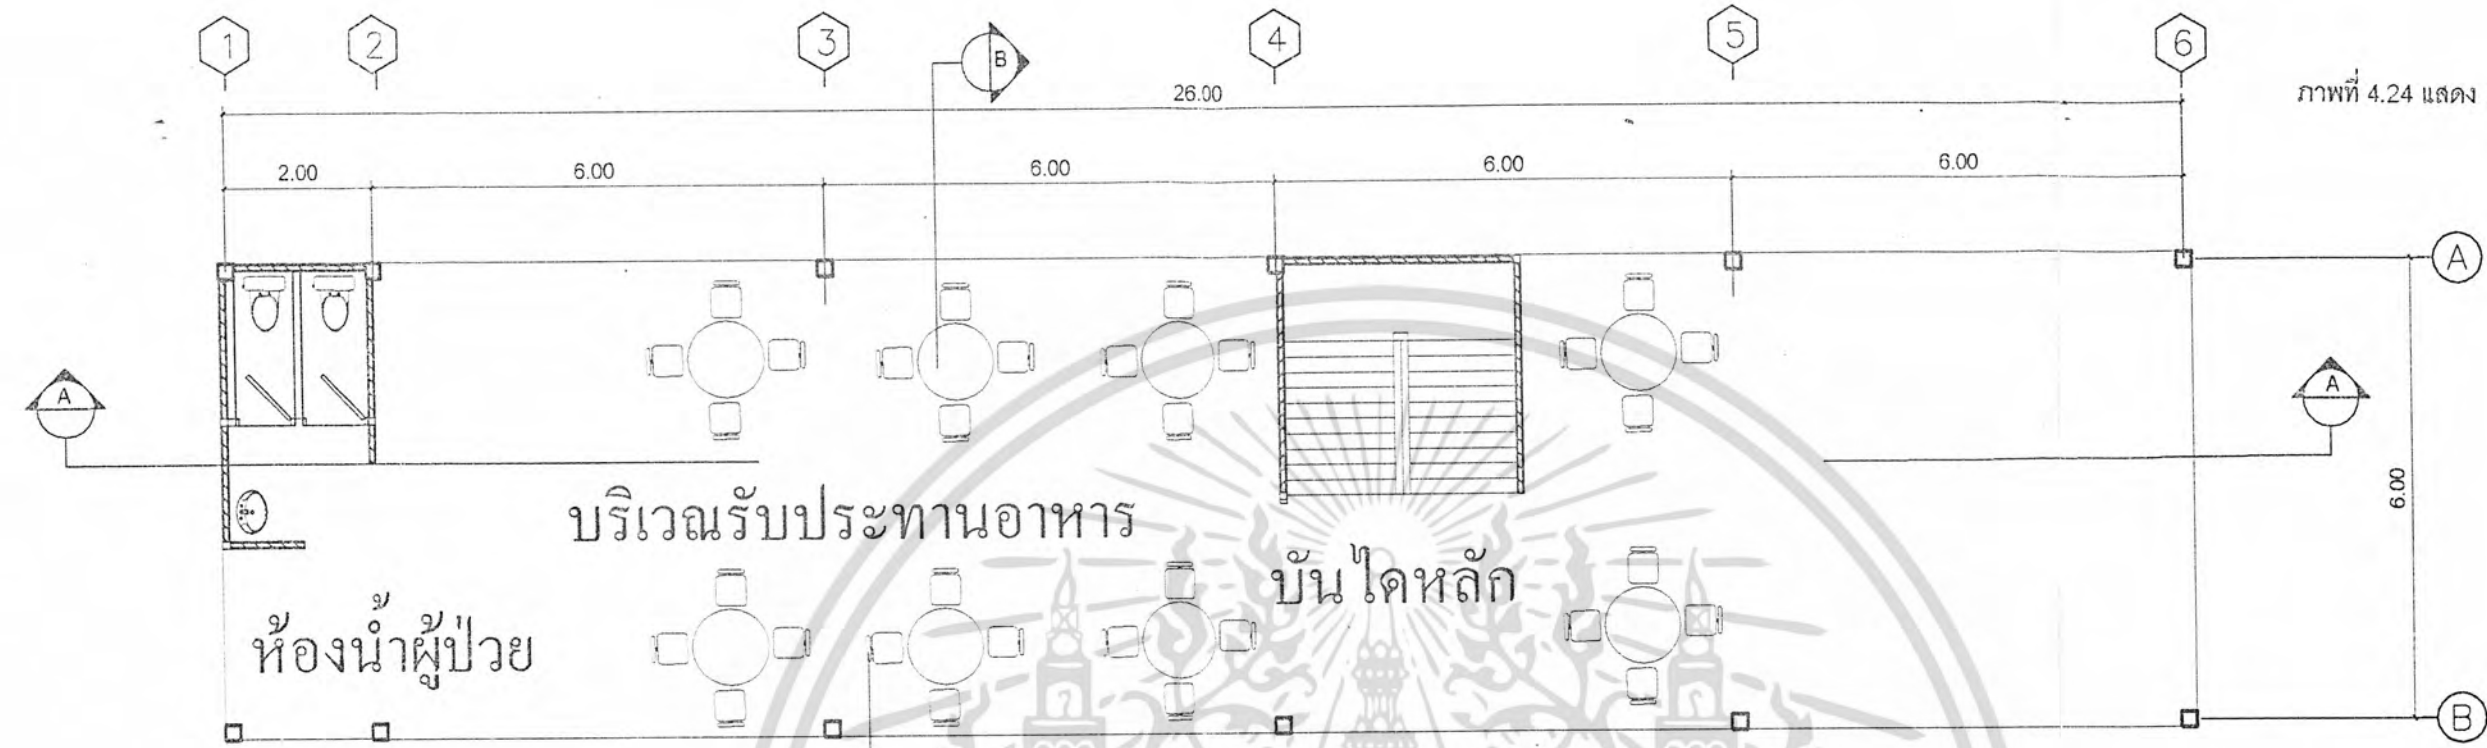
แสดง PLAN โรงอาหาร
